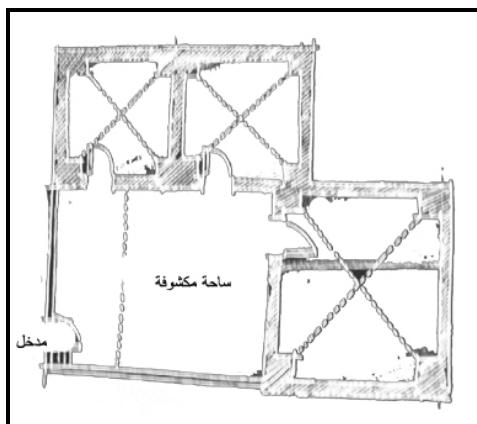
مخطط الطابق الأول لبيت ذو ساحة مكشوفة
